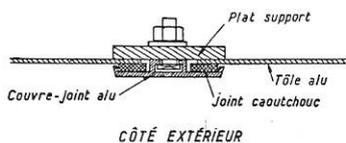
DÉTAIL DES COUVRE-JOINTS DES TÔLES, SEUILS ET FRISES.
